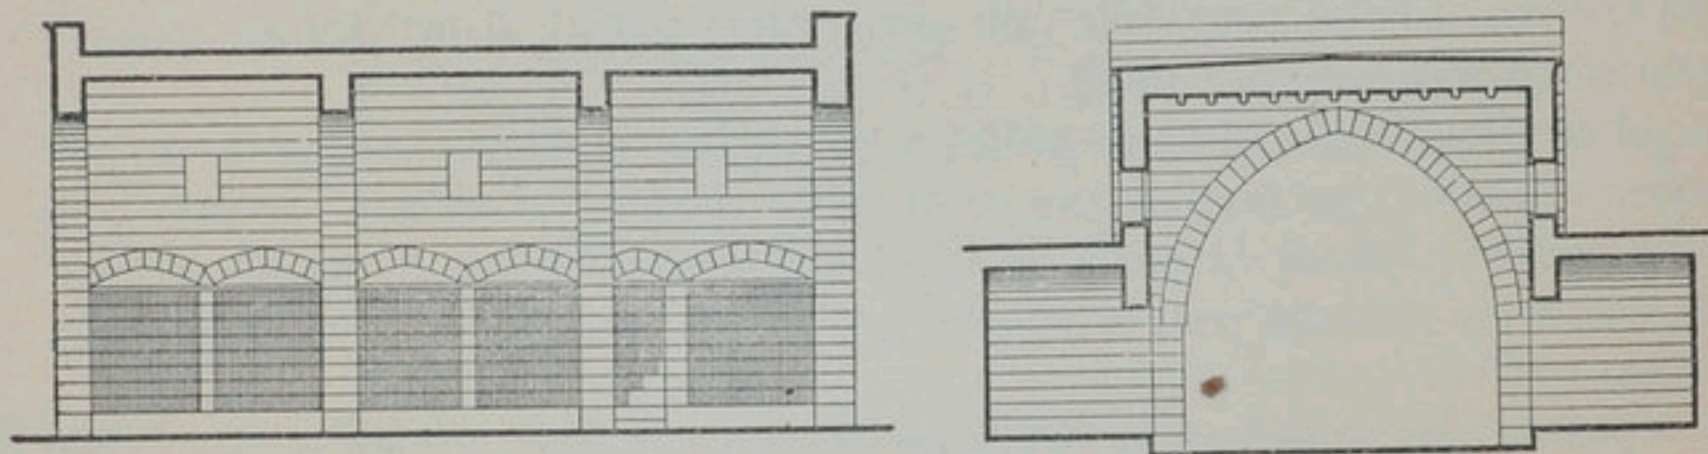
LA SOUEÏQA D'ABRAK dans le souk du vent (1510) : coupe longitudinale et coupe transversale (longueur hors-œuvre : 18 m.). — Cf. pl. XXI, au premier plan.
